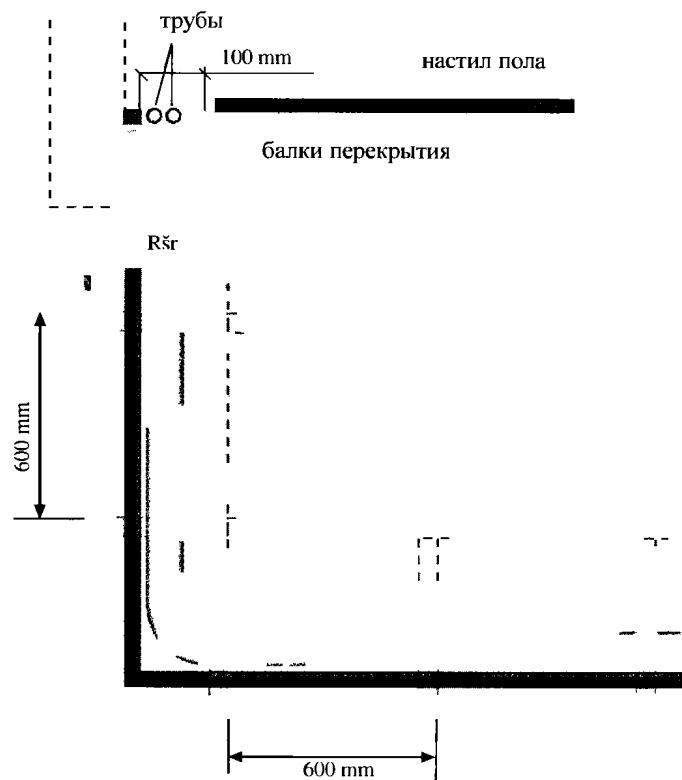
Пример укладки водопроводных труб в деревянных перекрытиях.
